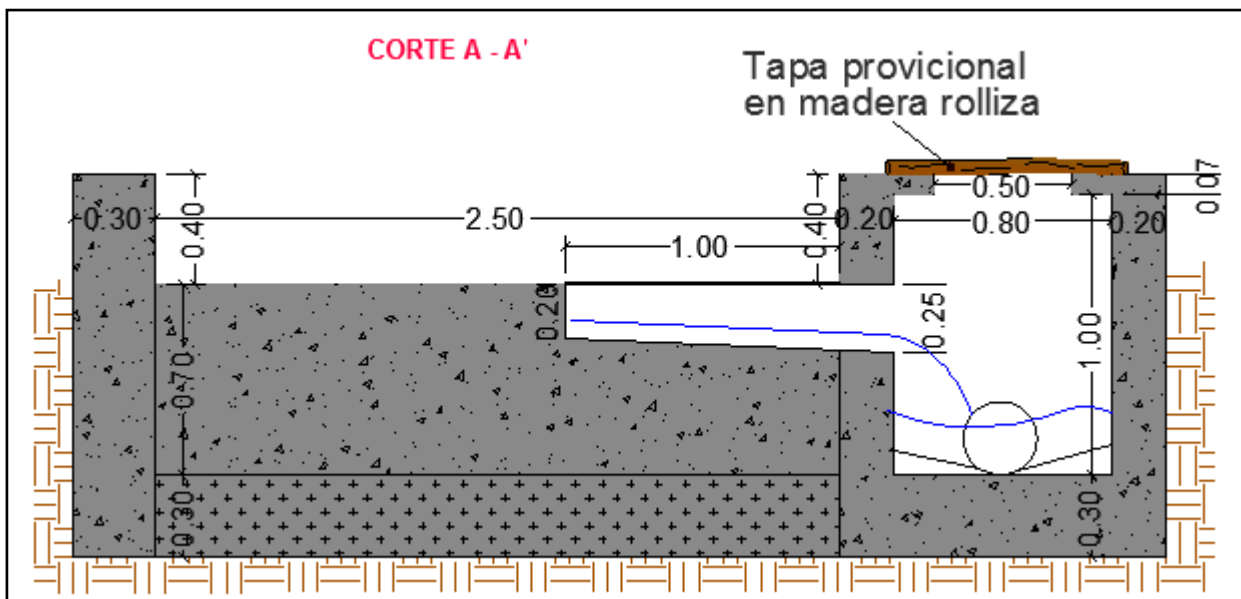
Sección transversal de la bocatoma existente. Fuente: Autores del proyecto.
